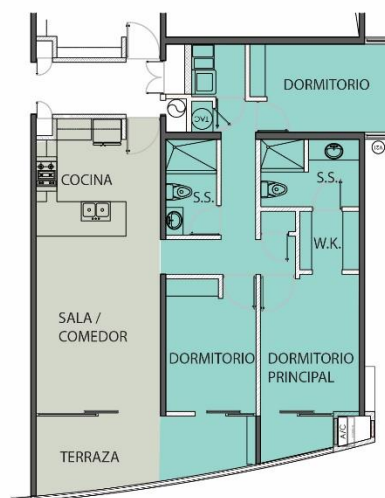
Detalle de plantas Apartamentos 1, 2 y 4 del Nivel 2° al Nivel 6°. Fuente: Elaboración propia
